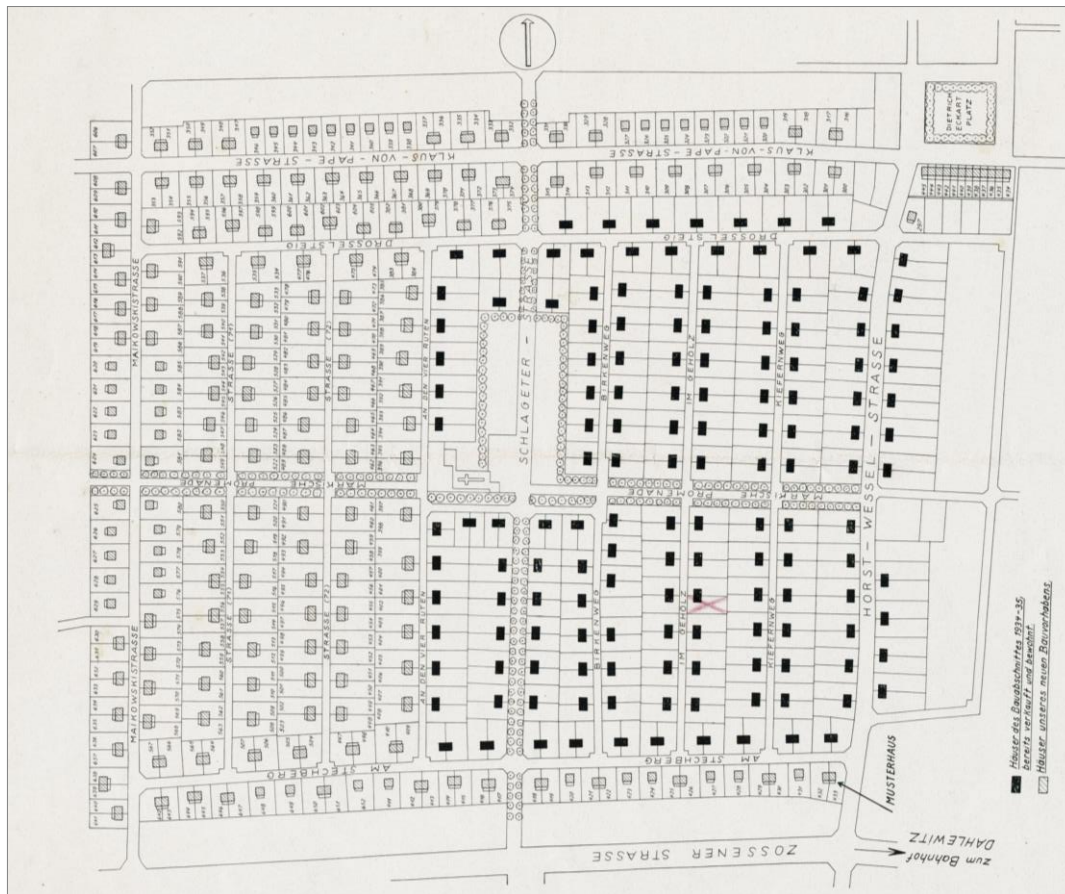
Lageplan der Siedlung (Entwurfsplan GAGFAH-OST, datiert 1942).
